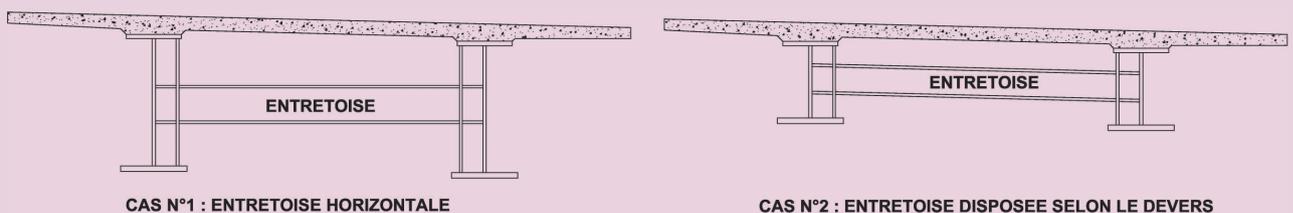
Orientation transversale des entretoises sur un ouvrage monodévers
